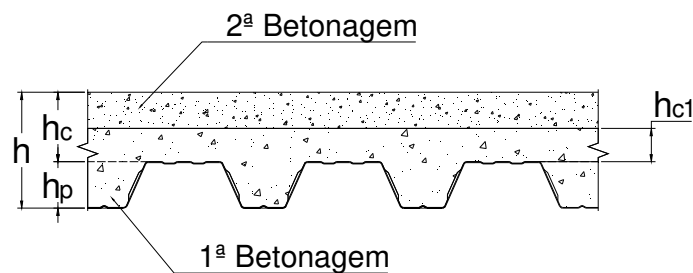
Execução de laje mista em duas fases (adaptado de (Calado & Santos, 2010))
